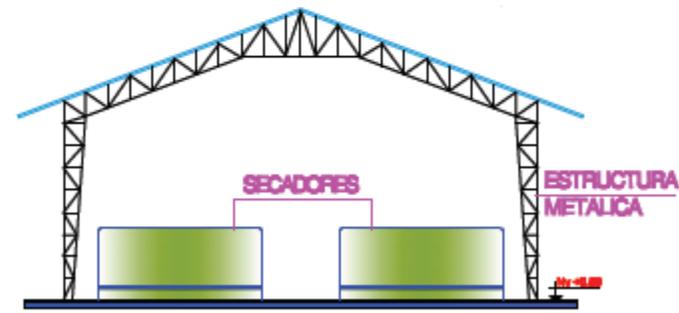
Fachada del centro de acopio con bodegas planas para maíz seco
